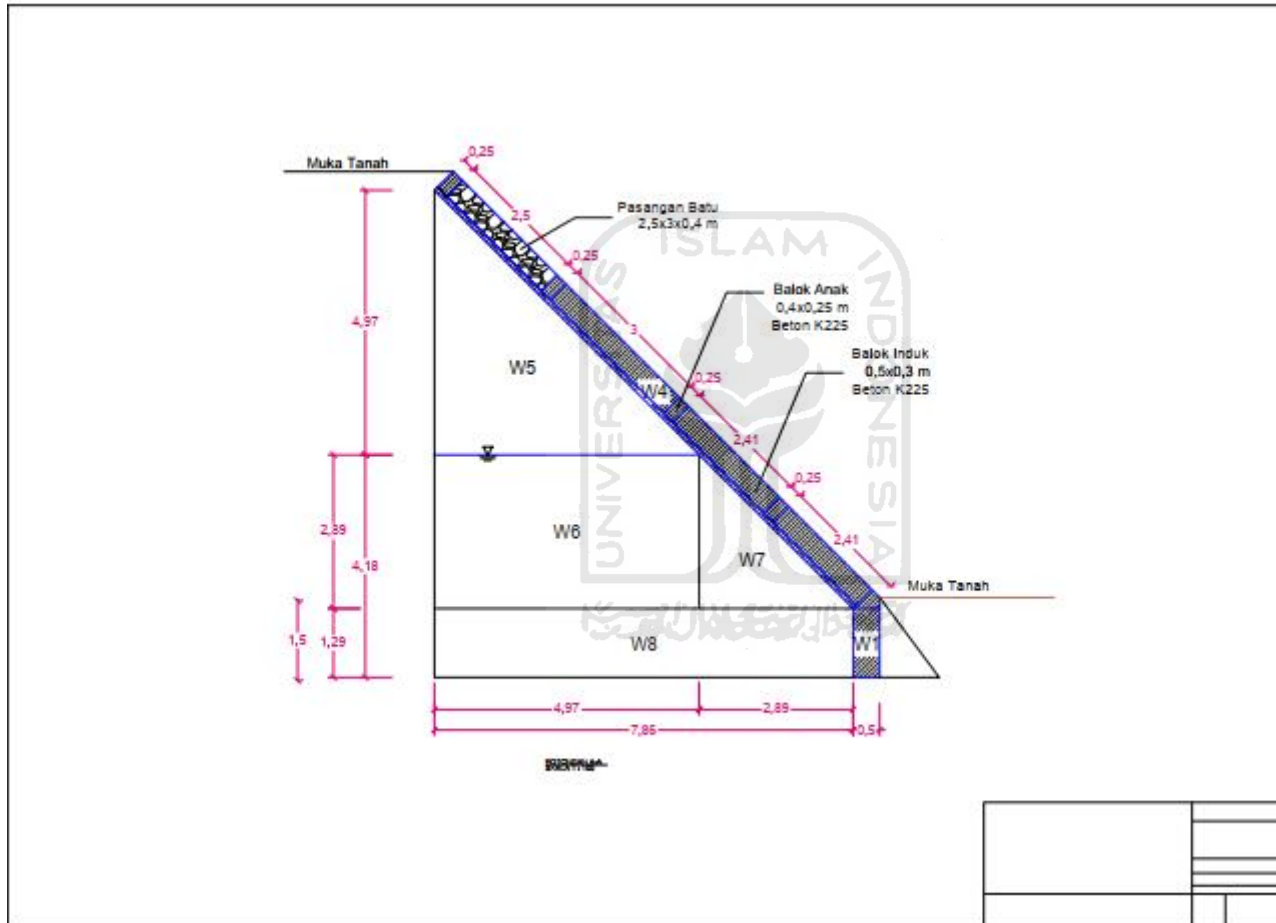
Cross Section Sungai Pada titik P2+50
